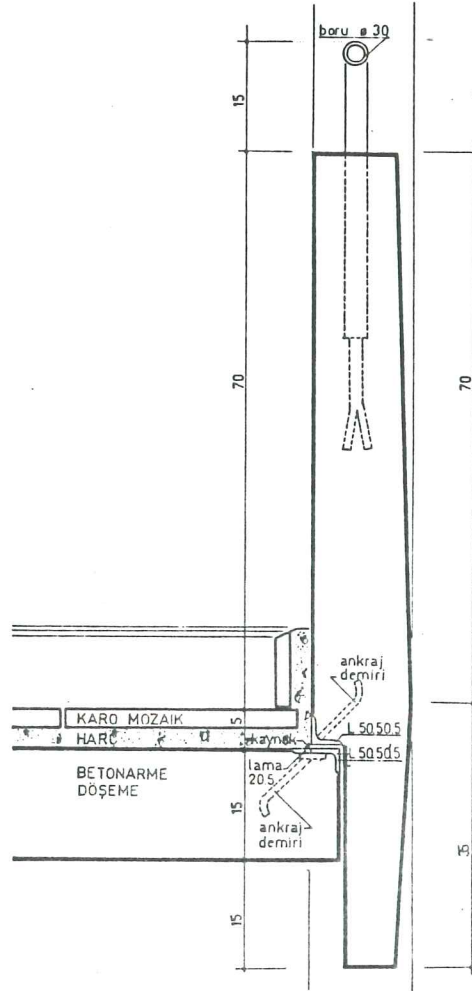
Prefabrike cephe panolarının birleşim detayı (Perkonsa'dan).
